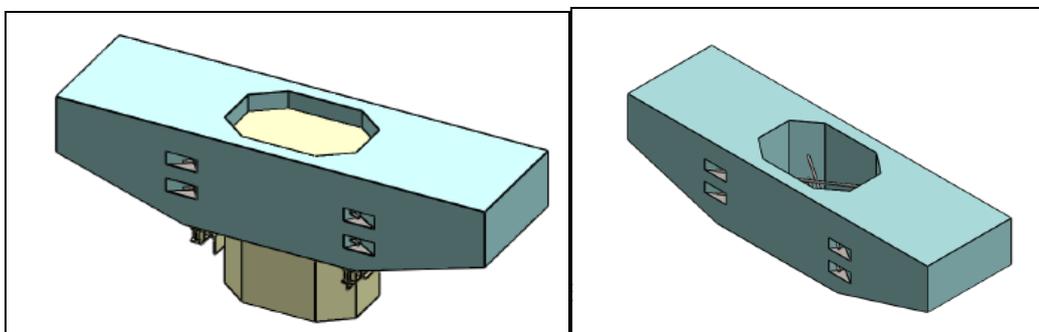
Imagen en 3D del segundo modelo para viga cabezal.
